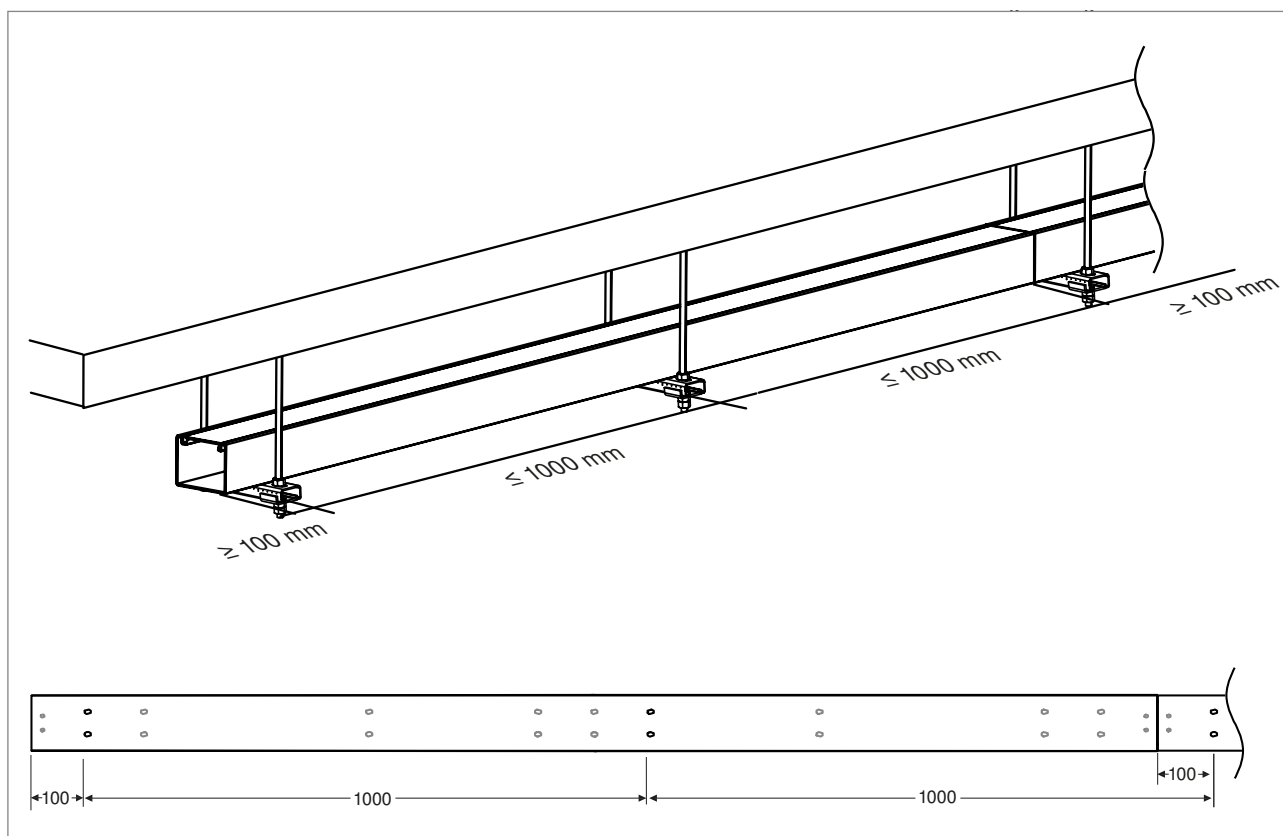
Espacements entre les supports et points de fixation sur le conduit
